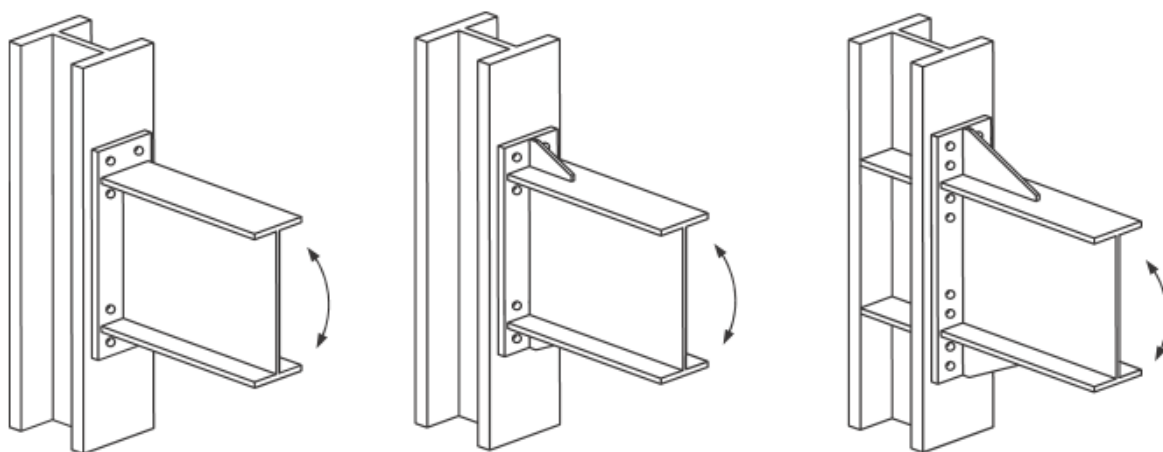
Tipos de conexiones de placa de borde. (American Institute of Steel Construction, 2005)
